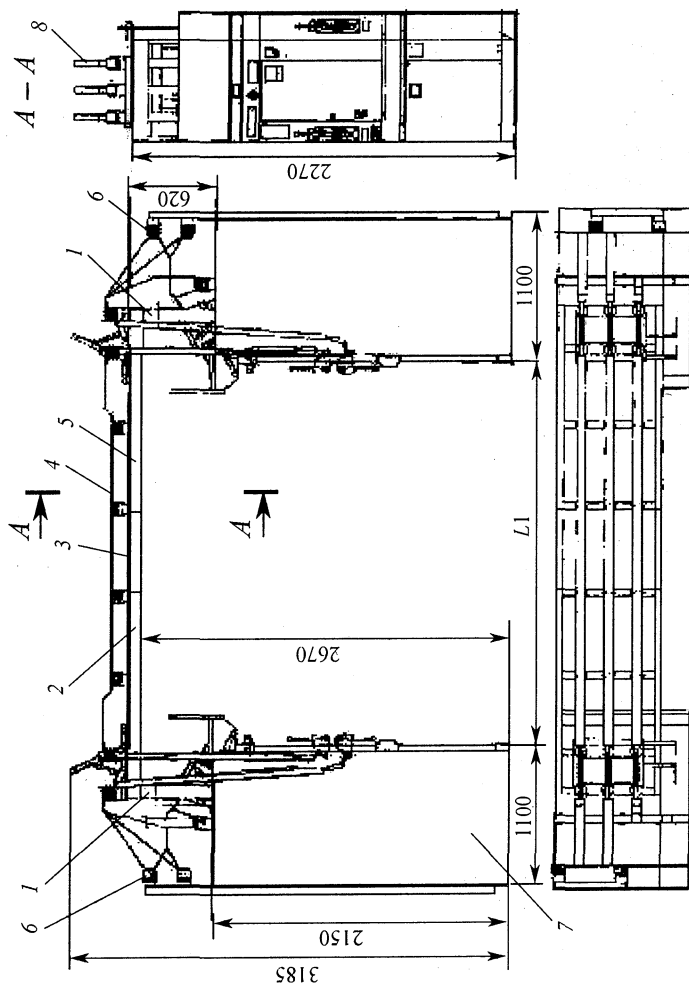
Шинный мост с разъединителями для камер КСО-298: 1 — опора; 2 — рама; 3 — вставка; 4 — шины; 5 — рама, 6 — изолятор; 7 — камера КСО-298; 8 — разъединитель
